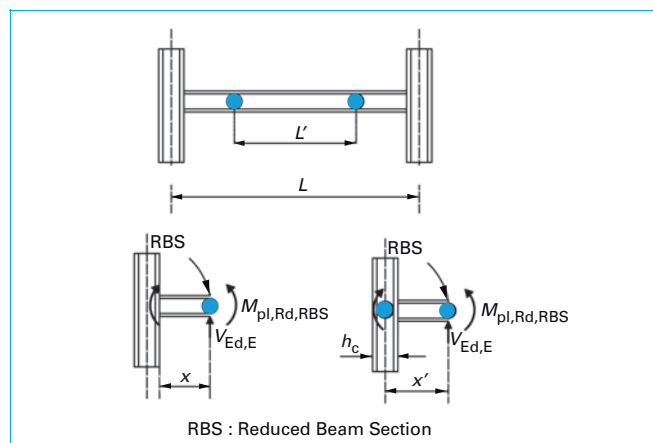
Calcul du moment de flexion et du cisaillement de l'assemblage en présence d'un affaiblissement de section de poutre ou d'une zone d'assemblage renforcée s'étendant jusqu'à X au-delà de l'axe du poteau (d'après [9])
